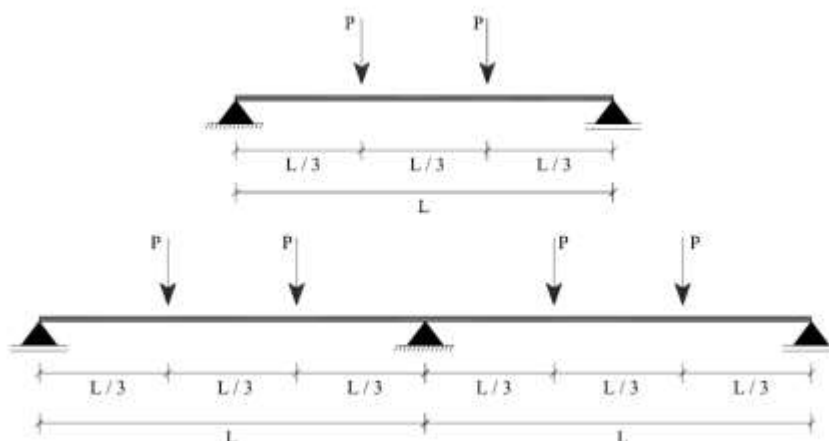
Vãos de vigas testadas por Nolasco [7].
